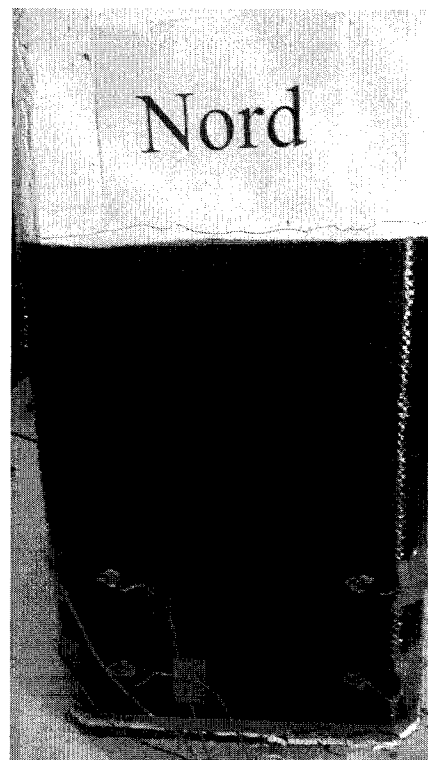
Photo de la face nord de S4 à la fin de l'essai
